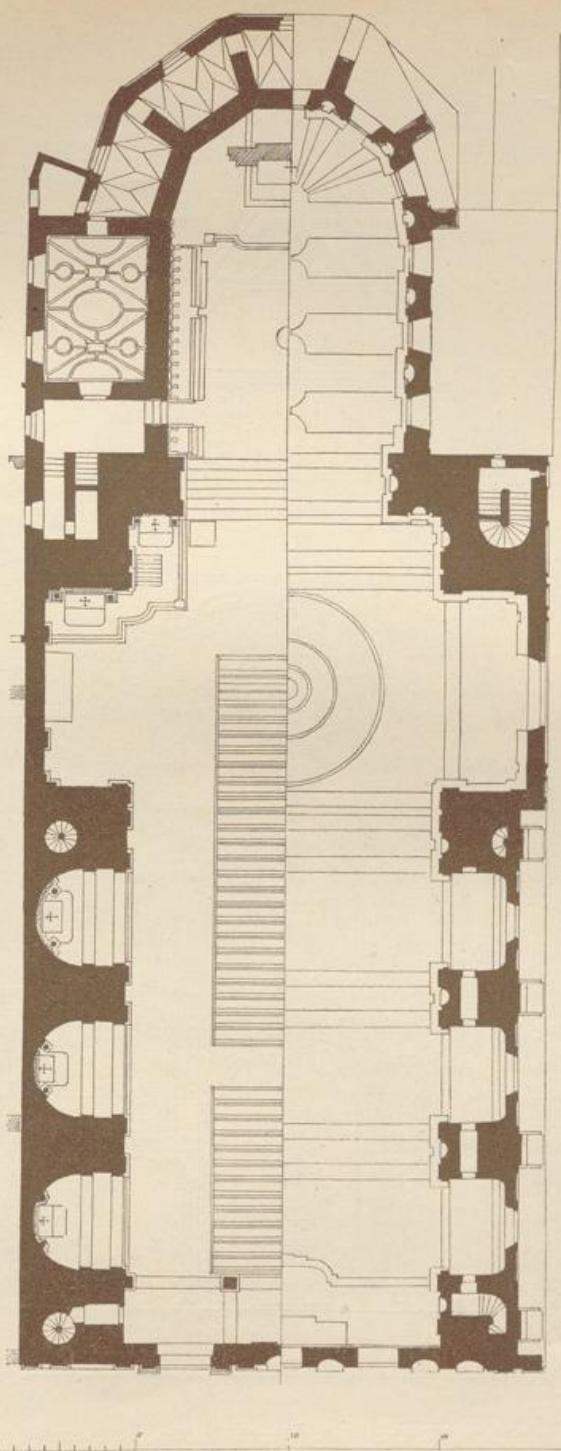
St. Michaeliskirche, München. Grundriss (n. Ortwein).
